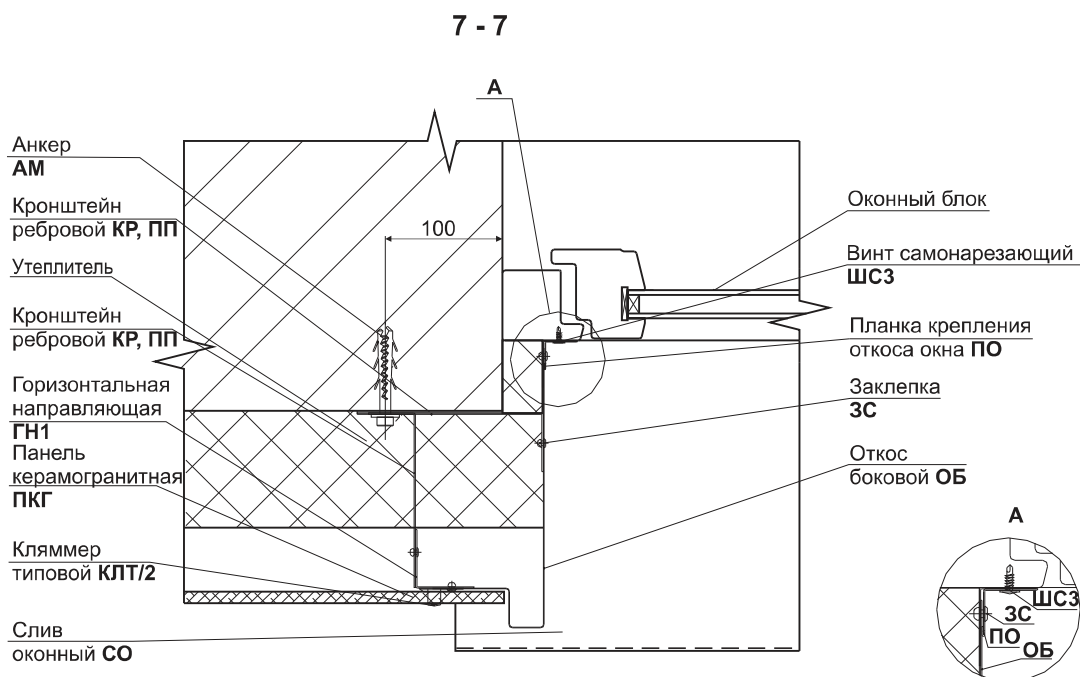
Узел облицовки бокового откоса на кронштейнах КР. Вариант 1.
